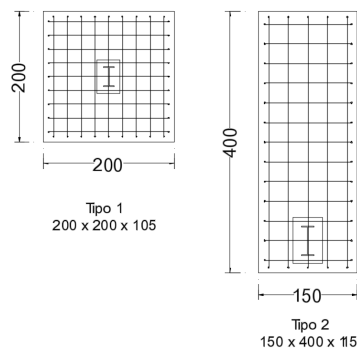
Esquema de las zapatas empleadas en la zona baja
